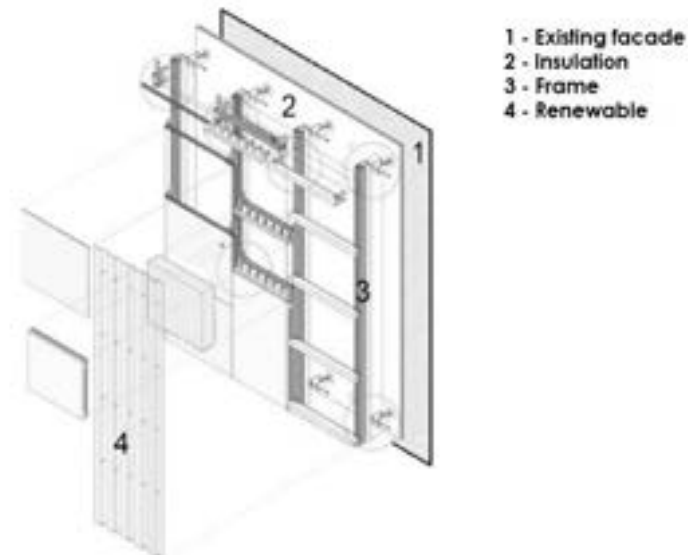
Progetto BRESAER – Schema di pannello prefabbricato modulare con sistema misto
